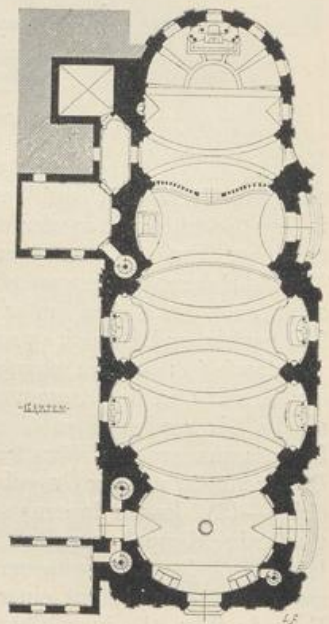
Grundriss von St. Margareth in Brschevnov
